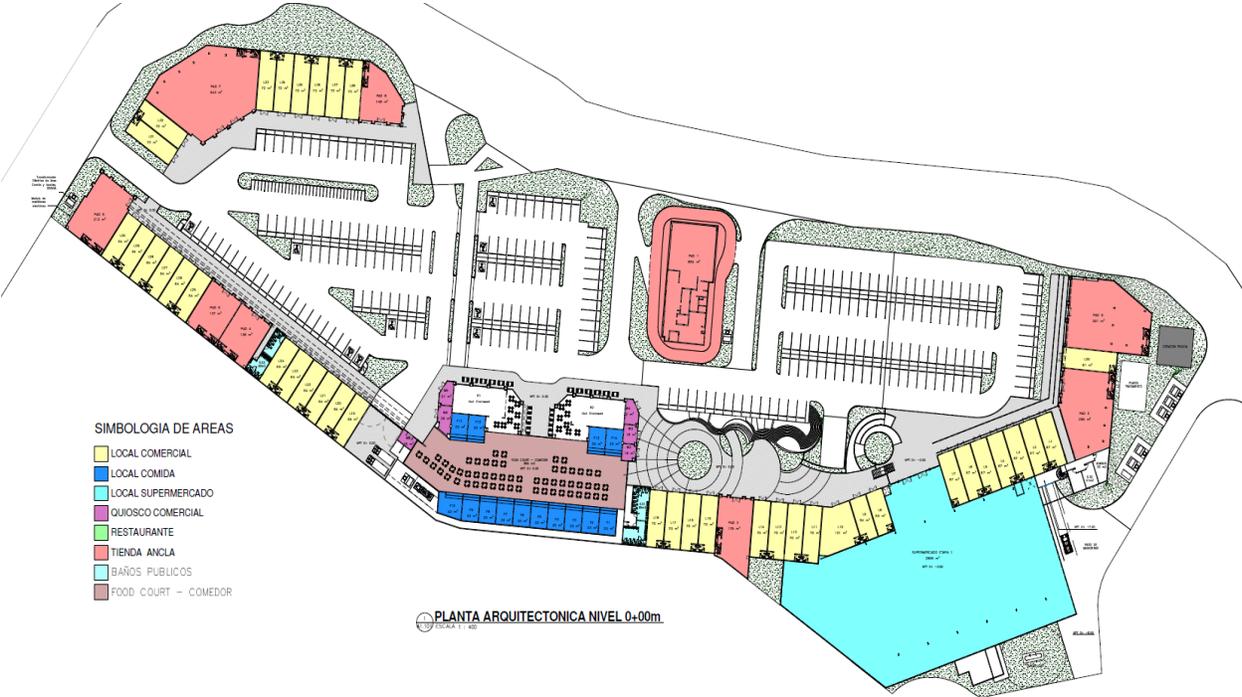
Planta arquitectónica El Encuentro Alajuelita
